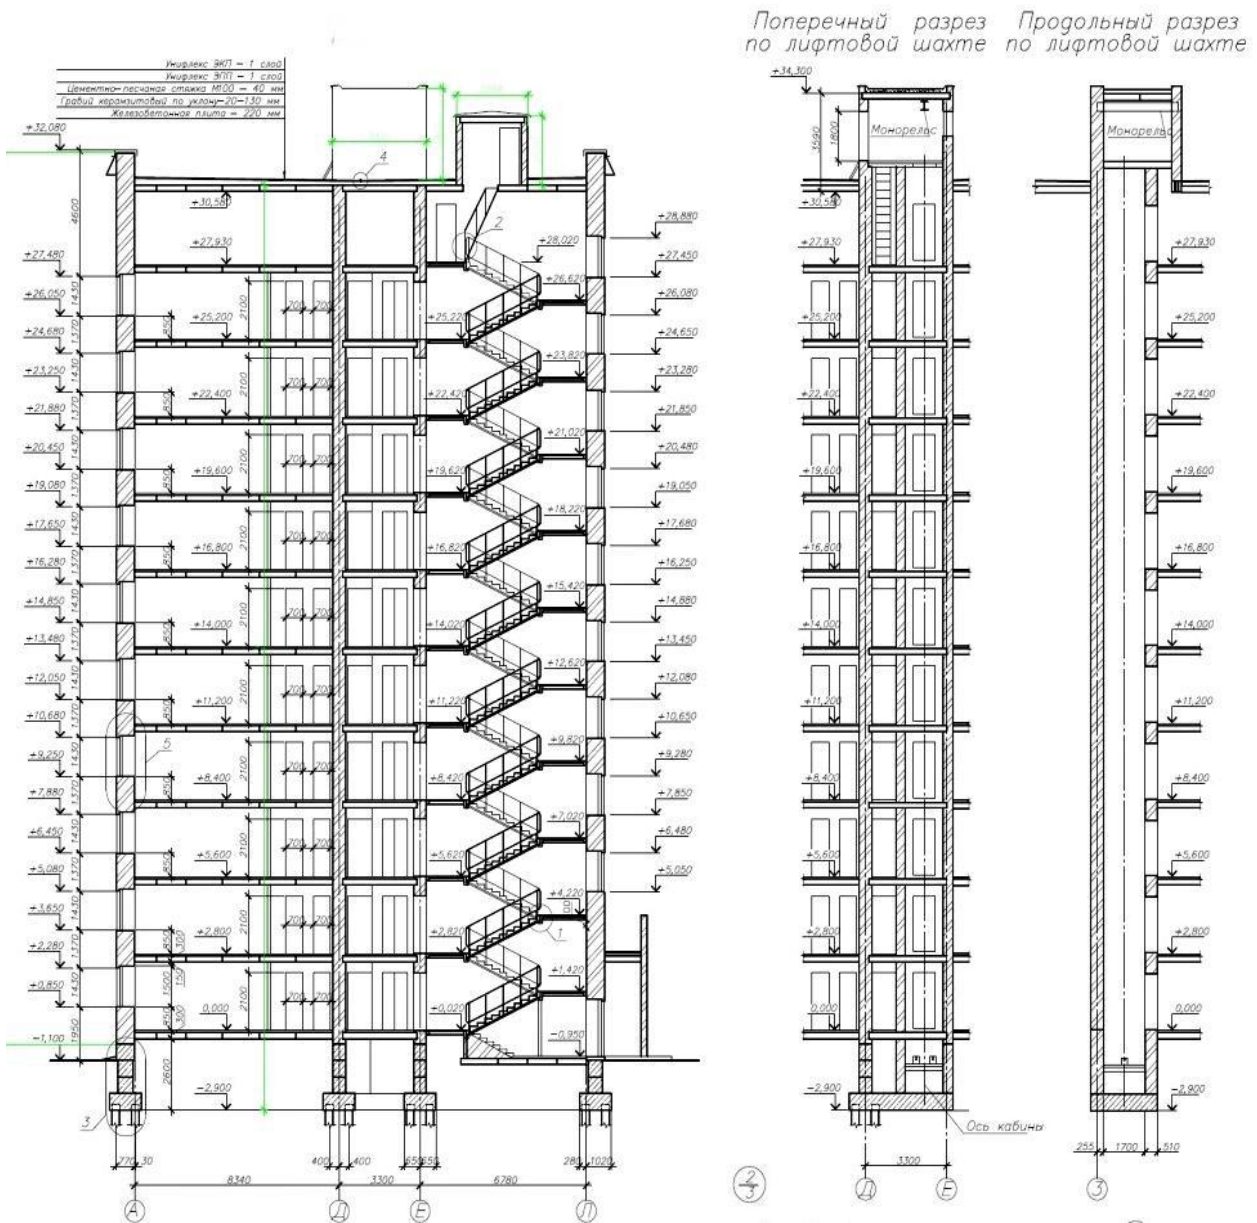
Поперечный и продольный разрезы жилого дома по лифтовой шахте
